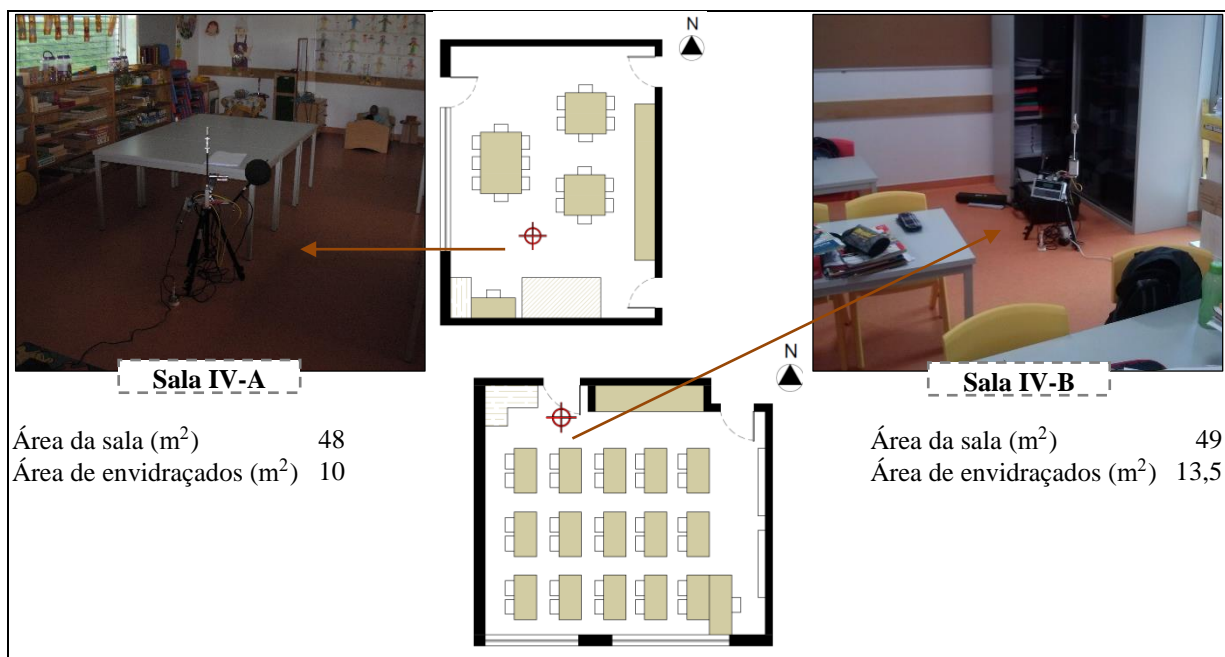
Localização do equipamento nas salas IV-A e IV-B
